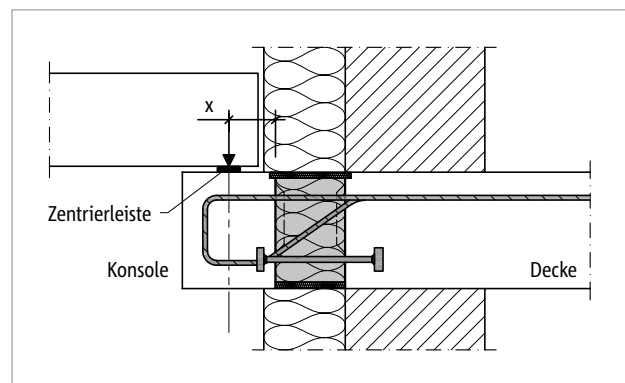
Schöck Isokorb® XT Typ O: Anschluss einer Konsole als Deckenaufleger; Zentrierleisten verhindern eine Verschiebung des Lastenleitungspunktes
